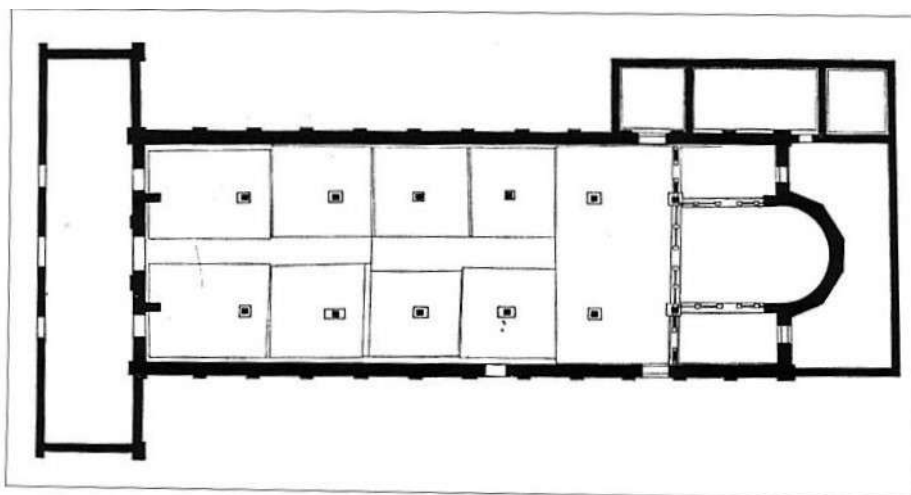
Pianta della seconda fase (dis. C. Previato 2017).
